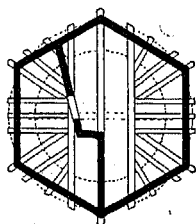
Grundriss des Fachwerkgeschosses.
